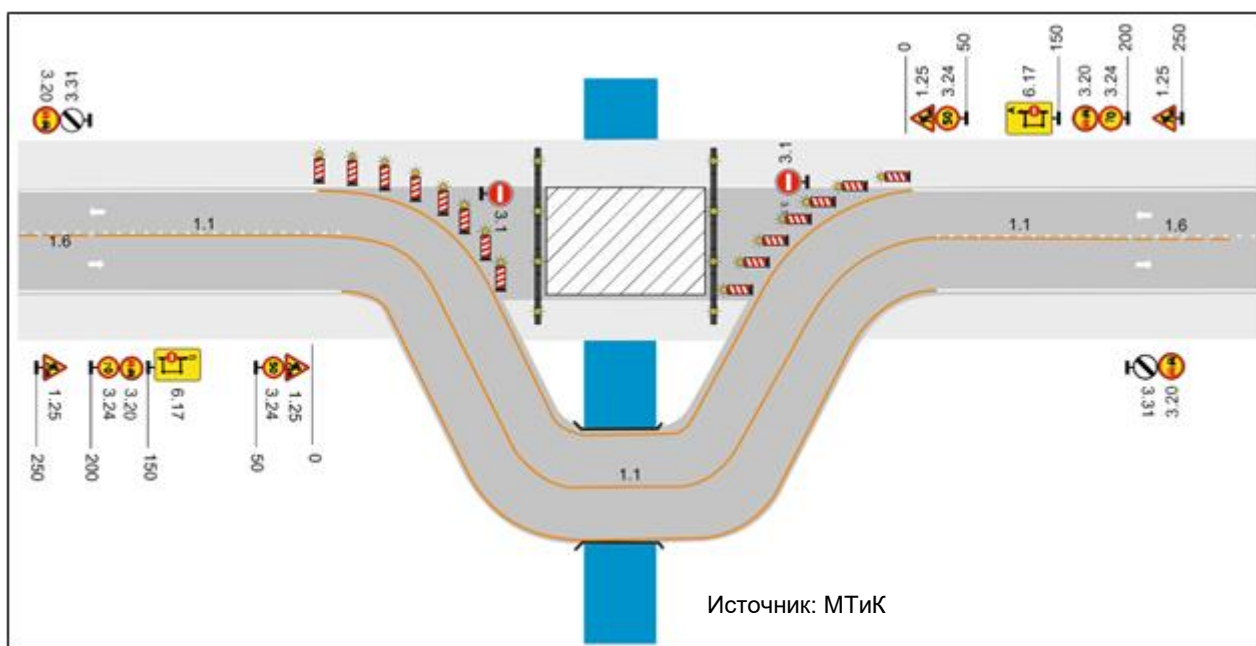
Рабочая зона для строительных работ на мосту и крупных водопропускных трубах.
